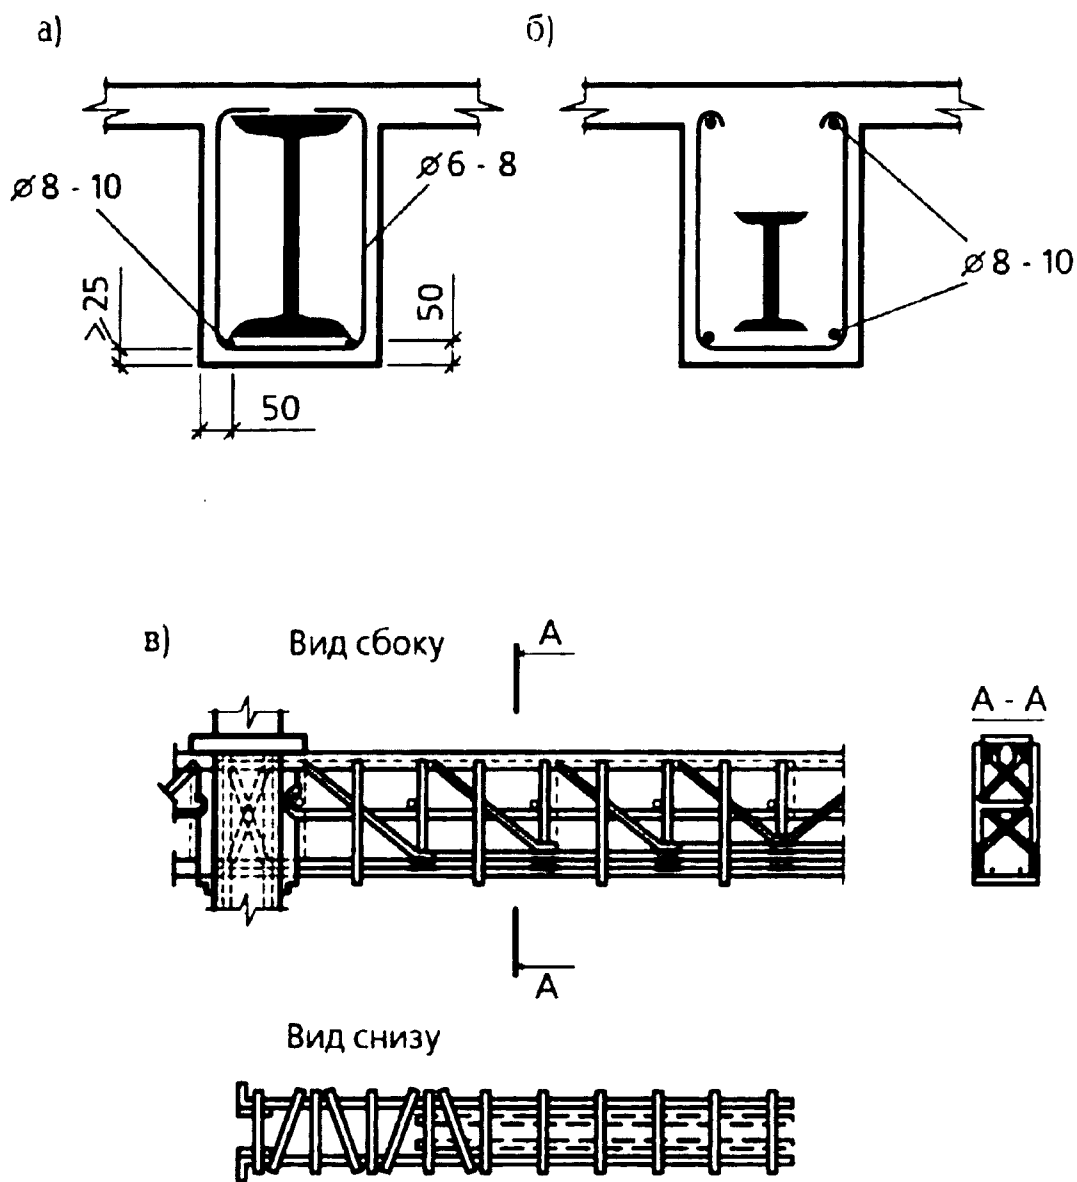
Армирование балок: а, б - жесткой несущей арматурой; в - сварным каркасом
